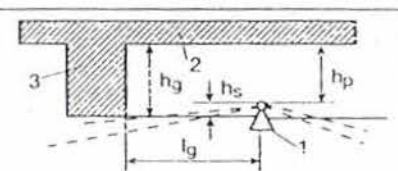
Distanțele de amplasare ale sprinklerelor față de planșee și grinzi: 1- sprinkler; 2 - placă; 3 - grindă.
